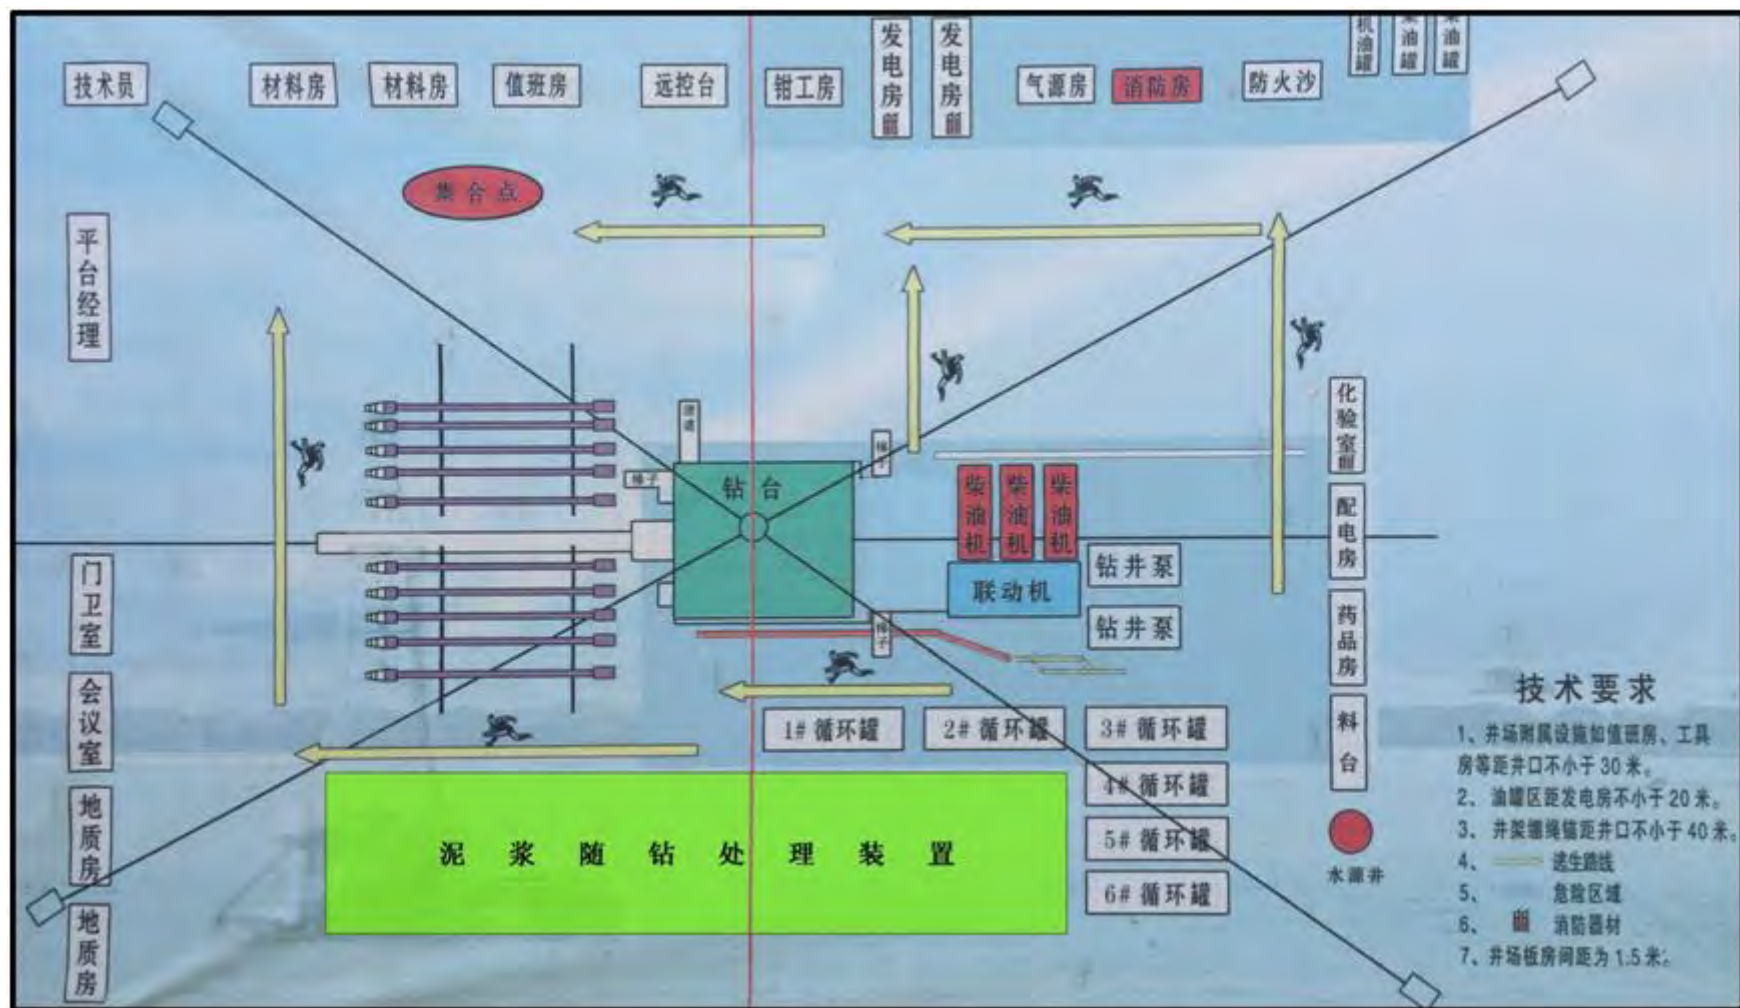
(b) 泥浆随钻处理钻井井场典型的平面布置图
